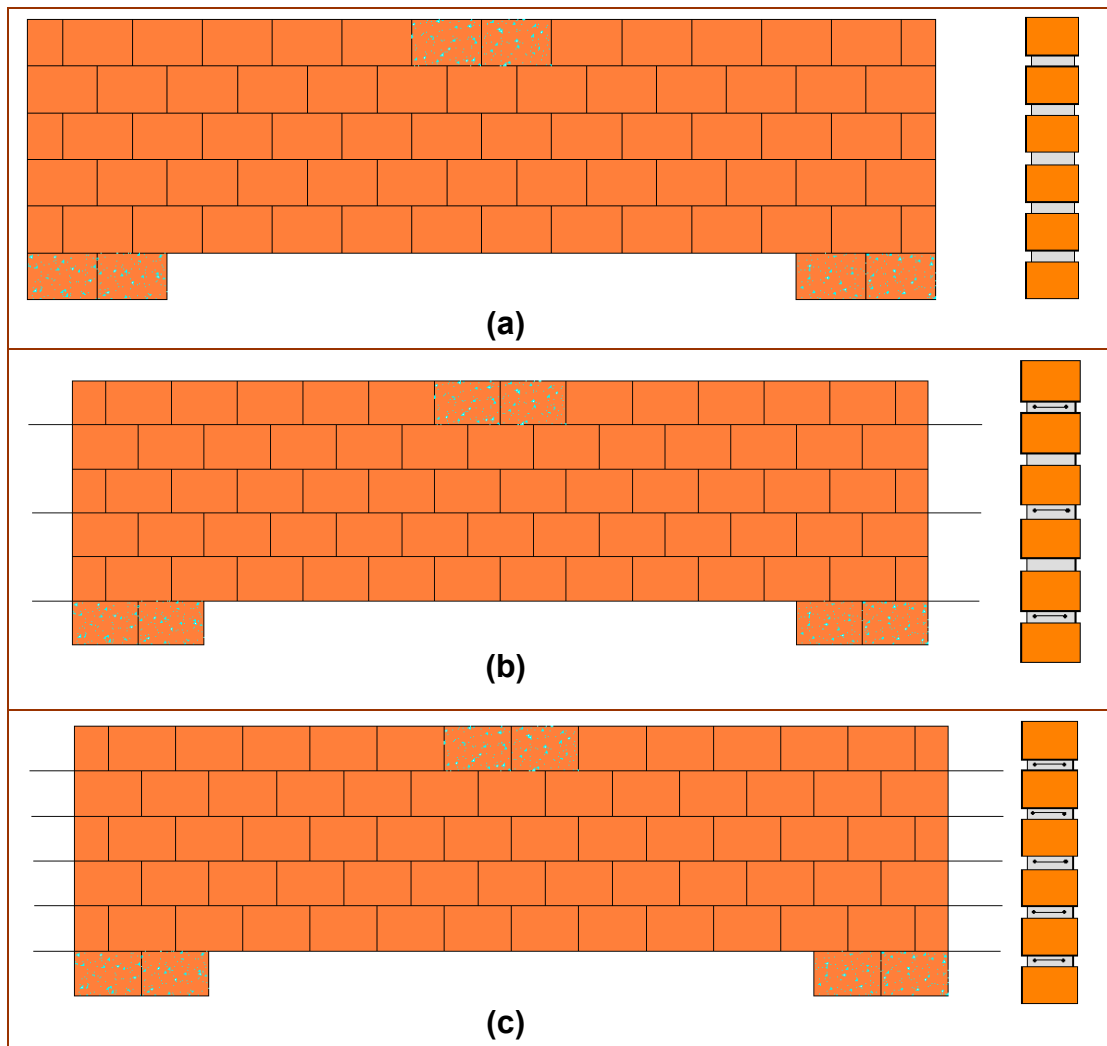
Modelos das mini-paredes ensaiadas: (a) Série 1 – sem armadura, (b) Série 2 – armadura imersa na argamassa a cada duas juntas horizontais, (c) Série 3 – armadura em todas as juntas horizontais.
